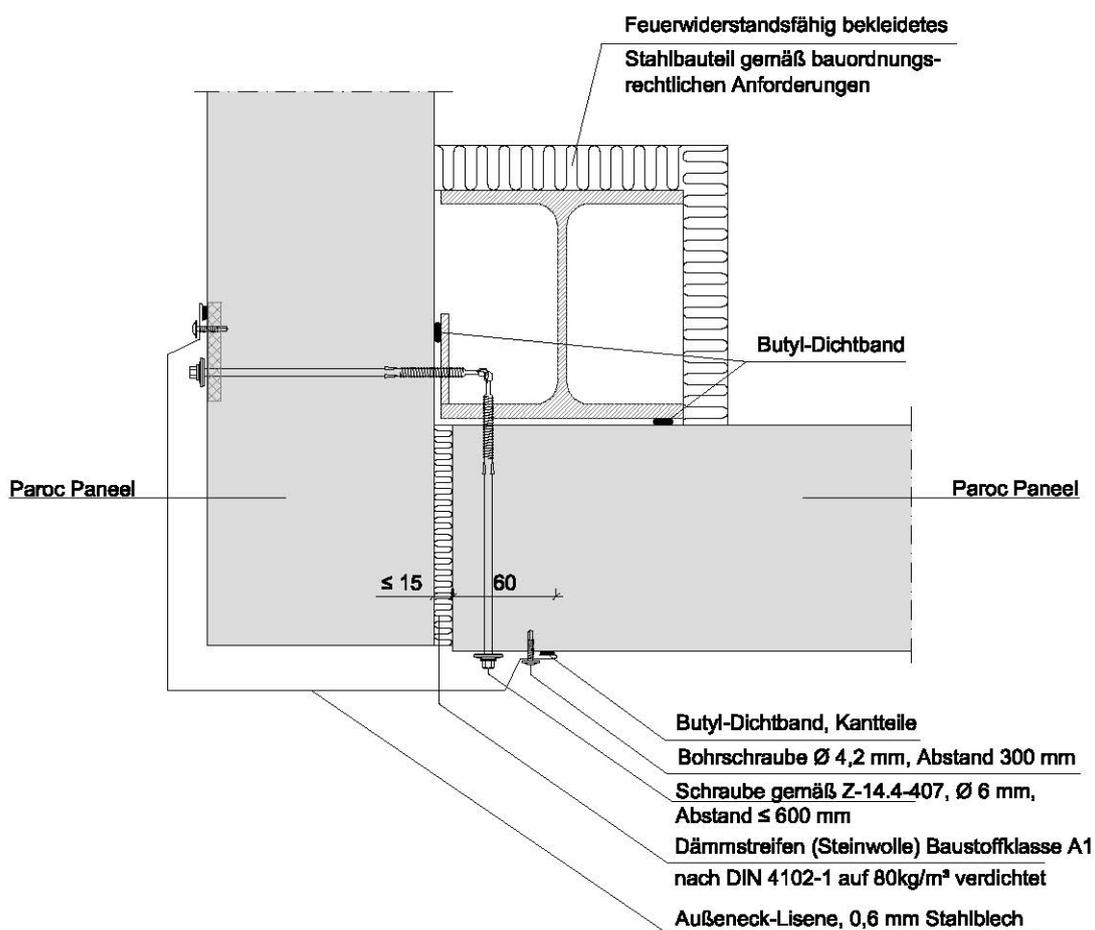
Detail konstruktiver Stützenanschluss Außenecke
